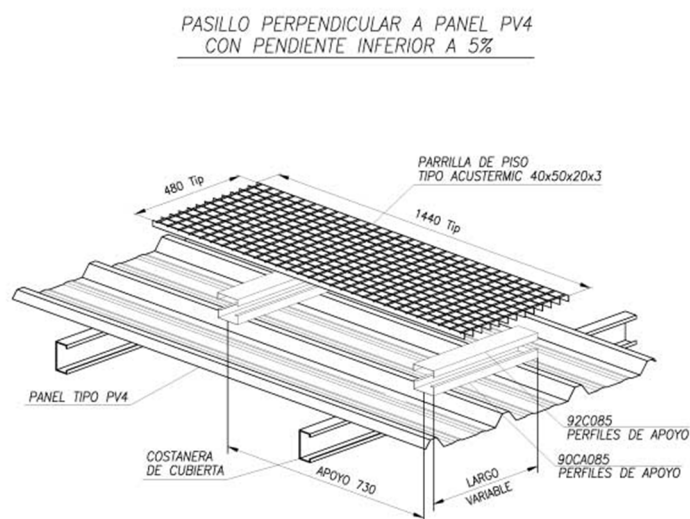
Detalle típico montaje pasillo técnico sobre cubierta plana.
